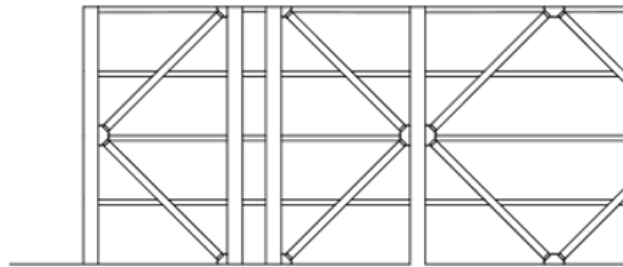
Unidad 5. Esquema de arriostramiento estructural [Figura] Elaborado por los autores en 2017
